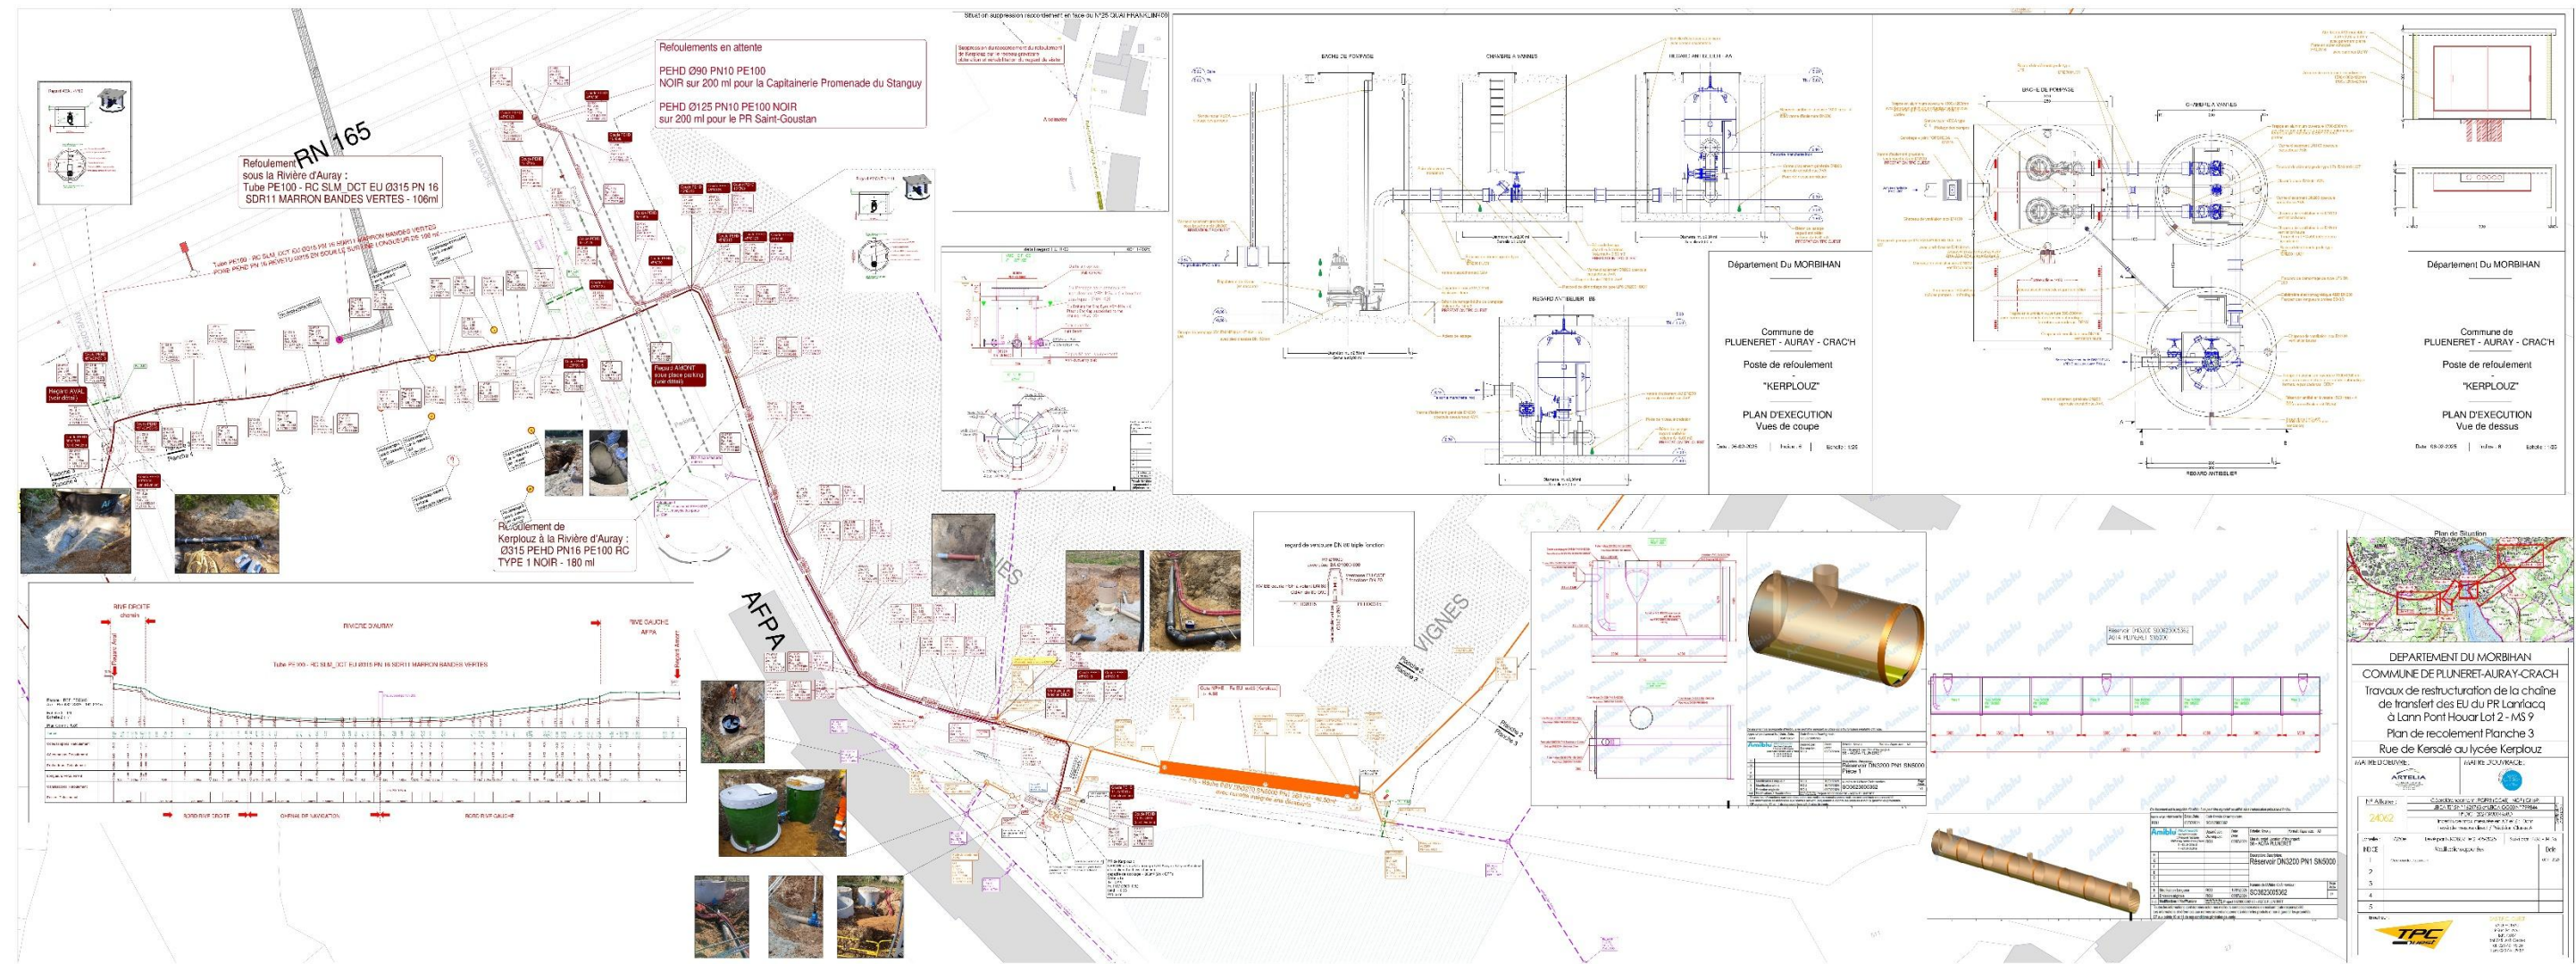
Plan de recollement de la traversée de la canalisation dans la rivière d'Auray
